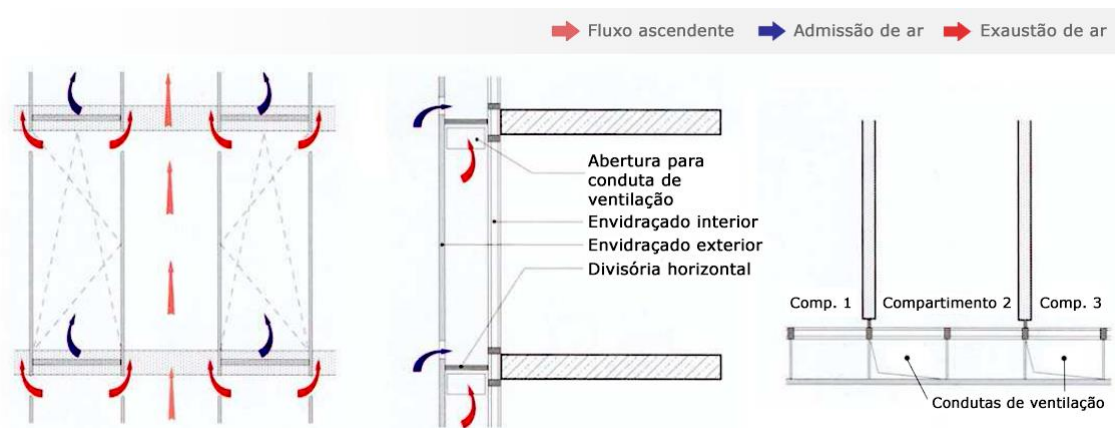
Geometria e esquema geral de ventilação de uma fachada do tipo “Chaminé”
